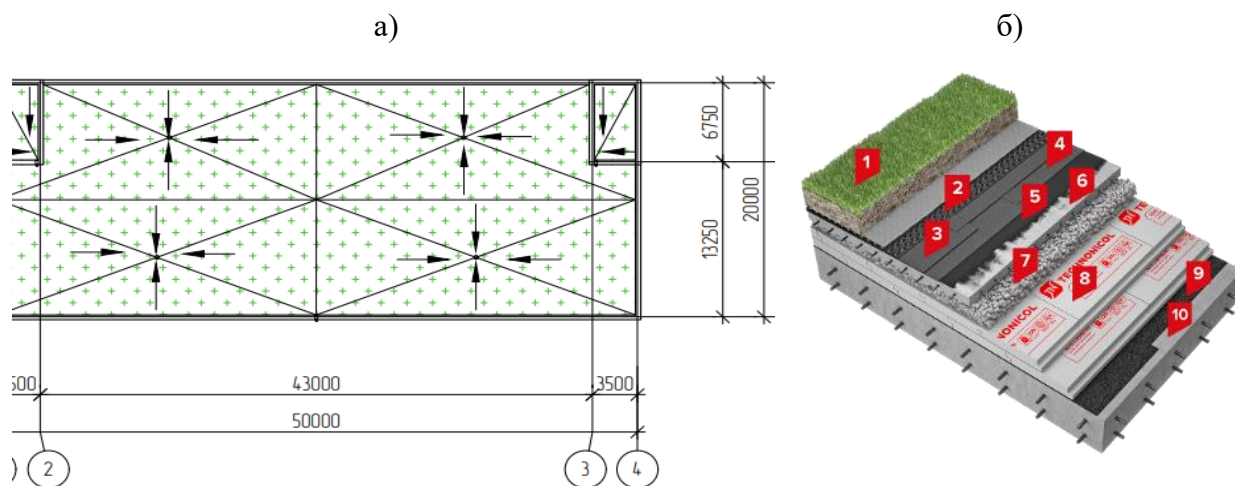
Экстенсивная «зеленая» крыша: а) план крыши; б) состав кровельного пирога: 1 – зеленые насаждения; 2 – профилированная мембрана; 3, 4 – гидроизоляция битумно-полимерная; 5 – битумный праймер; 6 – армированная цементно-песчаная стяжка; 7 – керамзитобетон в качестве уклонообразующего слоя; 8 – теплоизолирующий слой – экструзионный пенополистирол; 9 – пароизоляция; 10 – железобетонная плита
